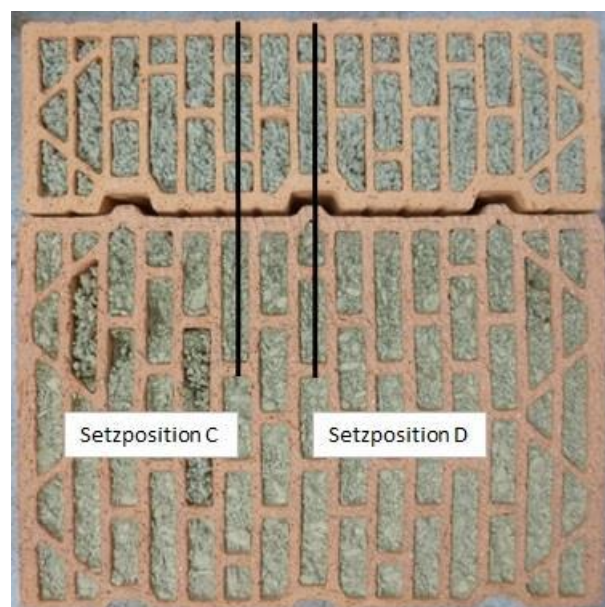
Setzpositionen der Dübel in wärmedämmenden PlanHLz
